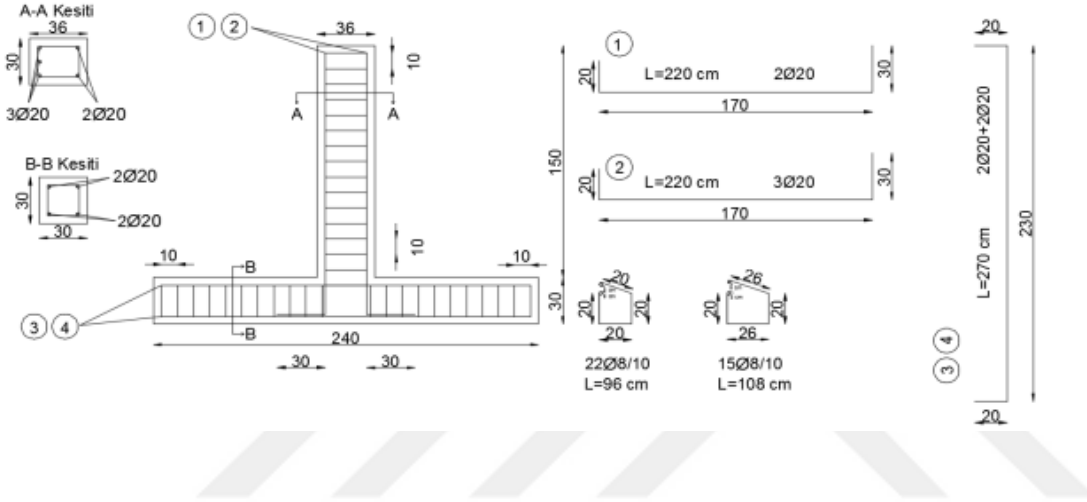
Referans-1 Elemanı geometrisi, donatı detayları ve kesit detayları
